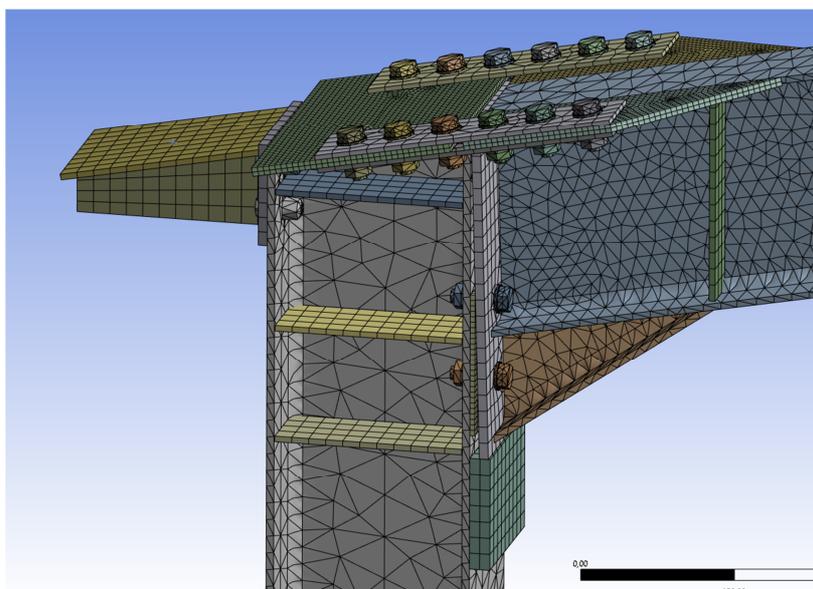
К расчету фланцевого узла с ошибками изготовления и монтажа
